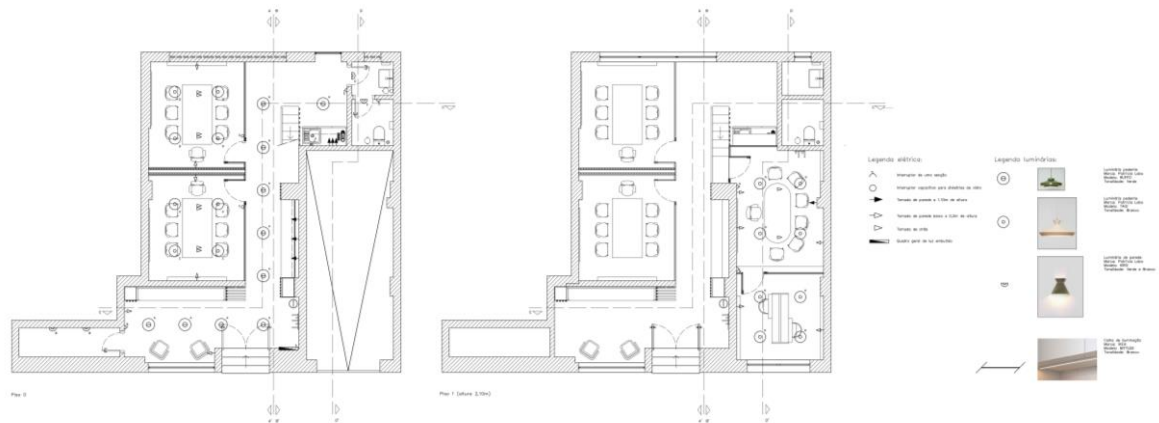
Planta de iluminação e tomadas piso 0 e piso 1. Fonte: Inês Rodrigues
